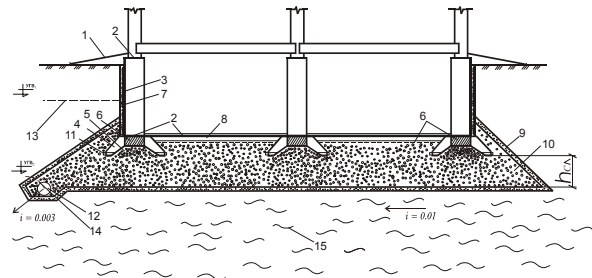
Комплексная защита здания от негативных последствий подтопления: 1 — отмостка; 2 и 3 — гидроизоляции; 4 — фильтрующий полый фундамент; 5 — внутренняя засыпка полого фундамента; 6 — железобетонный пояс фундамента; 7 — пристенный дренаж; 8 — пол подвала; 9 — слой песка средней крупности; 10 — искусственный дренируемый слой основания (щебень или гравий); 11 — отверстия для отвода воды; 12 — дренажная труба; 13 — непониженный уровень грунтовых вод; 14 — пониженный уровень грунтовых вод; 15 — глинистый слабопроницаемый грунт
